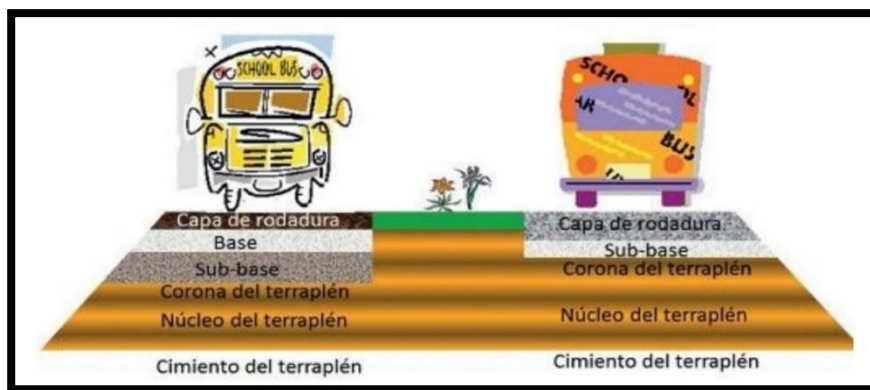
La estructura habitual de los pavimentos flexibles y rígidos.
